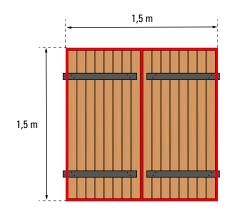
Position des sources de porosité d'un volet traditionnel (traits rouges)
